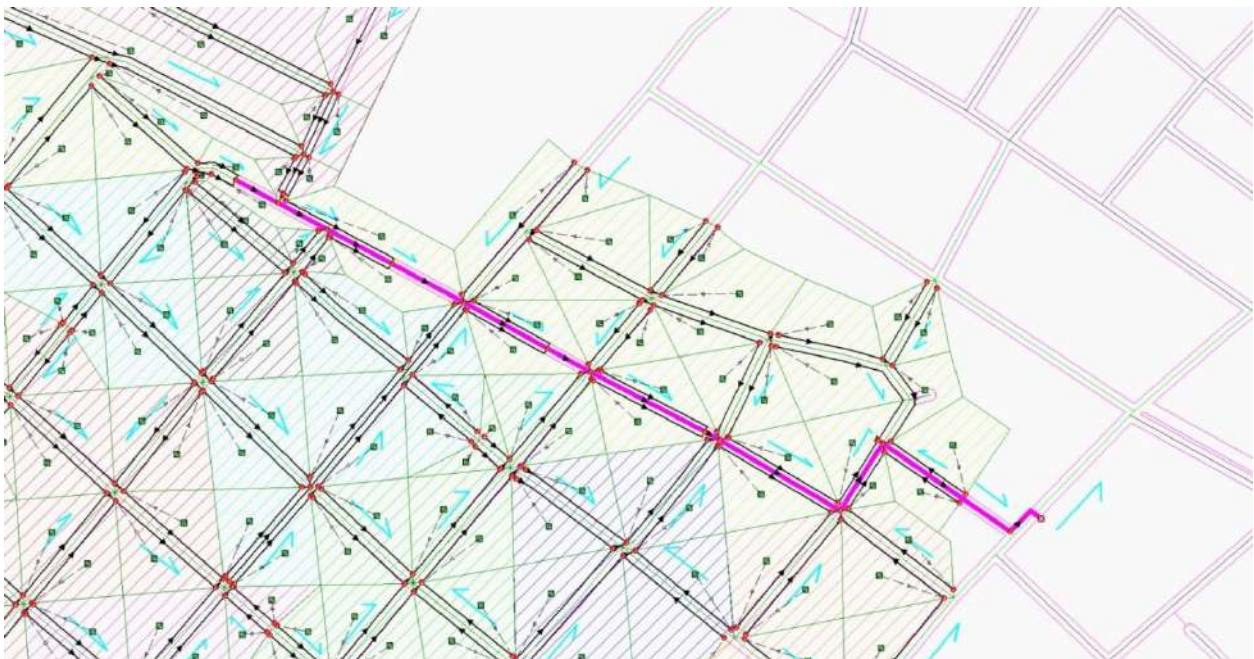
Esquema en planta de la simulación del alcantarillado de la solución propuesta sobre las calles San Pedro – Juan León Mallorquín – Caacupé y tramo Rutapy08
